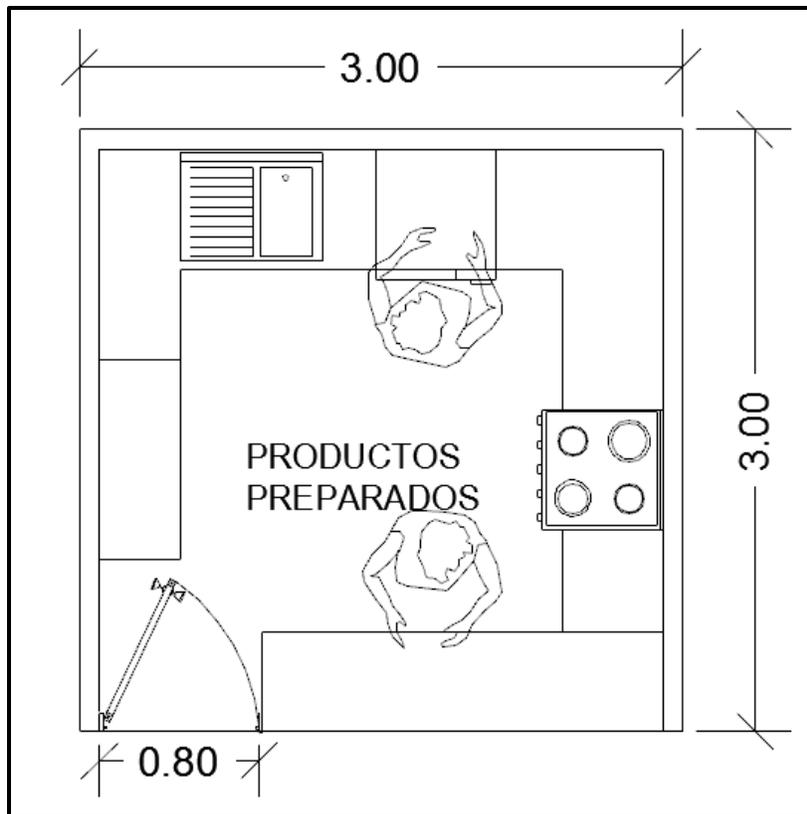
propuesta distribución en planta PRODUCTOS PREPARADOS SIN ESCALA
